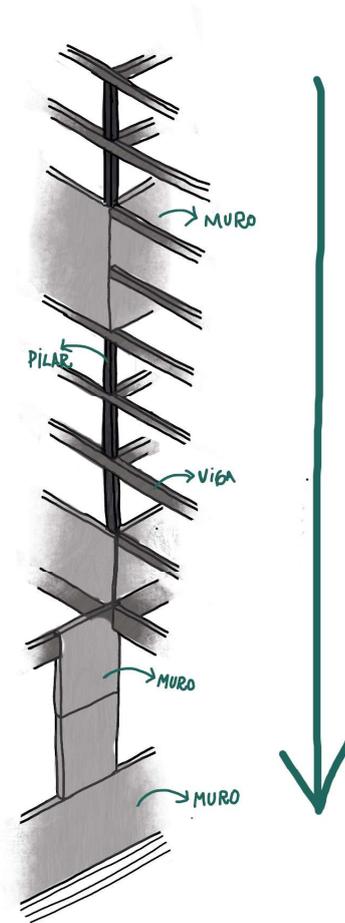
Ejemplo estructuración eje. Fuente: *Elaboración propia
